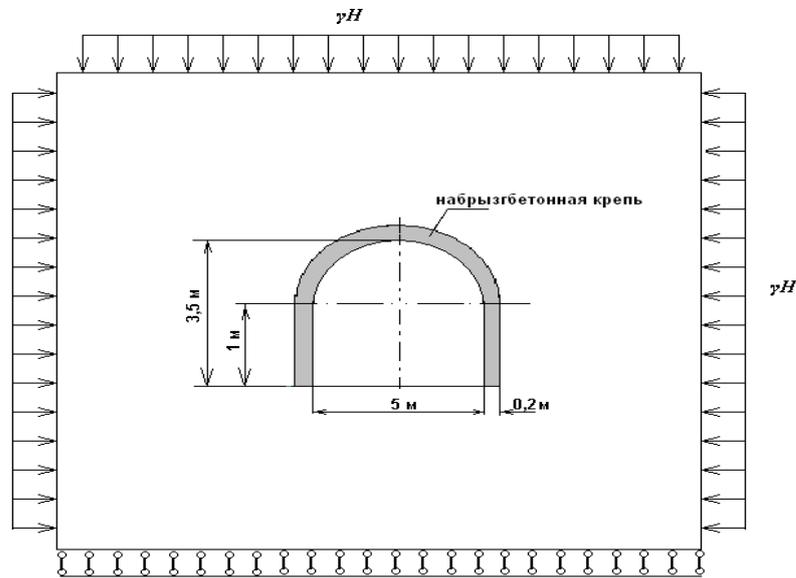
Расчетная схема выработки с набрызгбетонной крепью, толщиной 20 см
